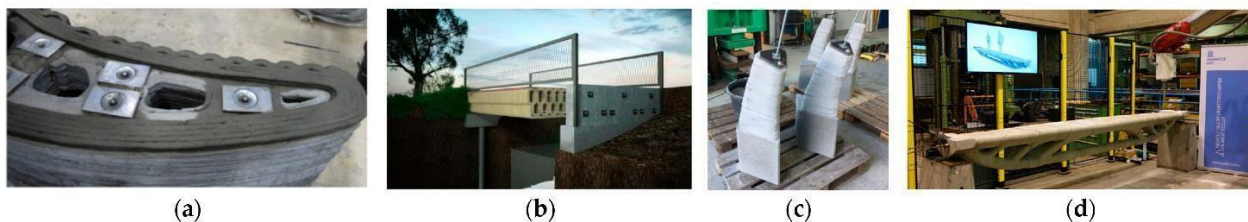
Надруковані бетонні елементи, посилені за допомогою додаткового натягу: а - бетонна лавка; б - концептуальний проект бетонного мостового покриття ВАРМ; с - бетонна колона; д - бетонна балка.
